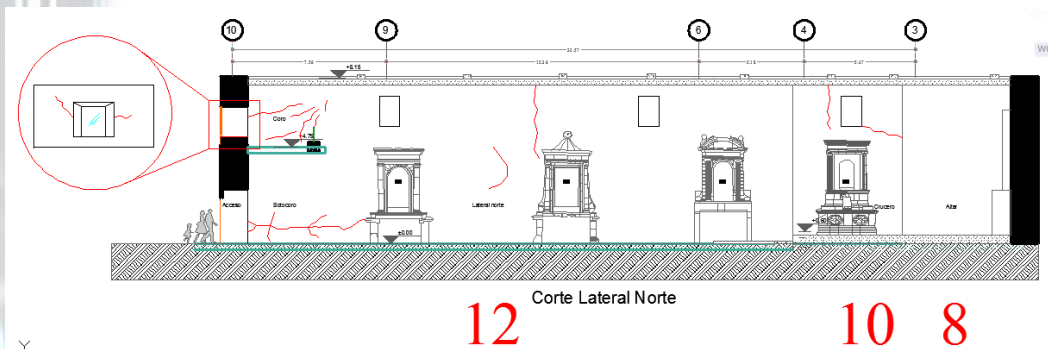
Muro lateral norte; muestra de grietas
